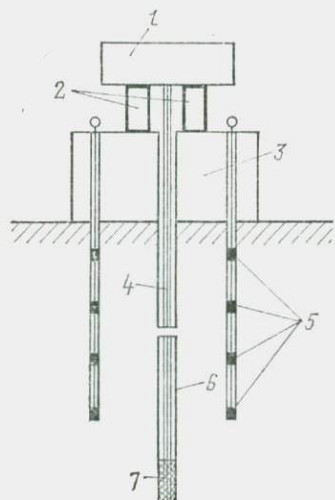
Схема штамповых испытаний скальных грунтов с применением тросового анкера:
